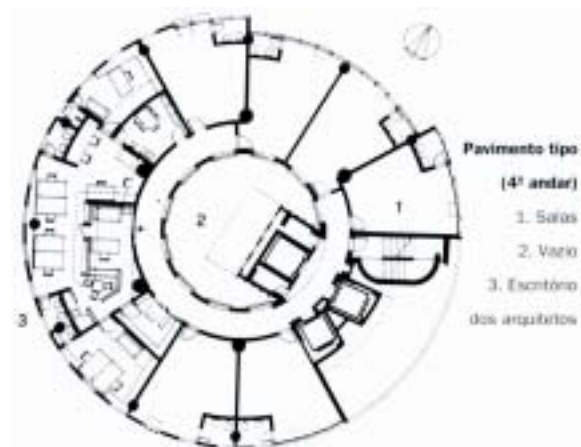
Condomínio Officenter (1989): planta andar tipo.
